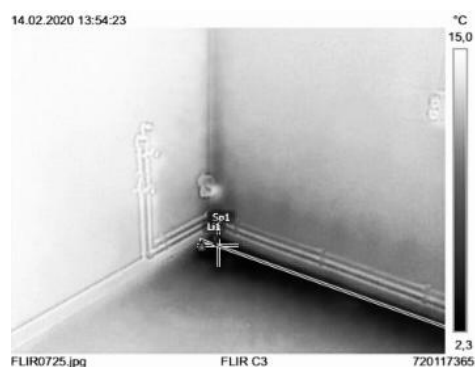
Наиболее холодное примыкание стены к цокольному перекрытию (объект 2)
